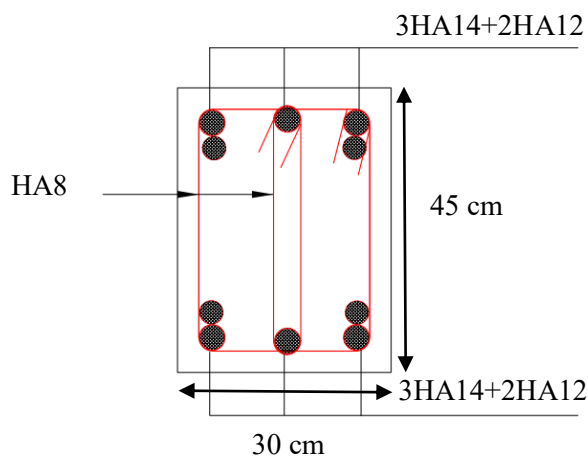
Ferrailage des poutres principales en appuis 30x45
